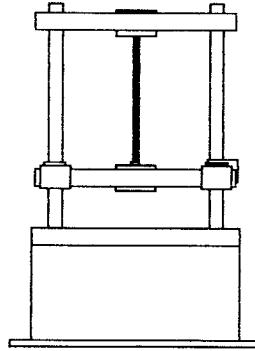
Pengujian Elemen Sambungan 2 Baut dengan tebal plat 2,8 mm
